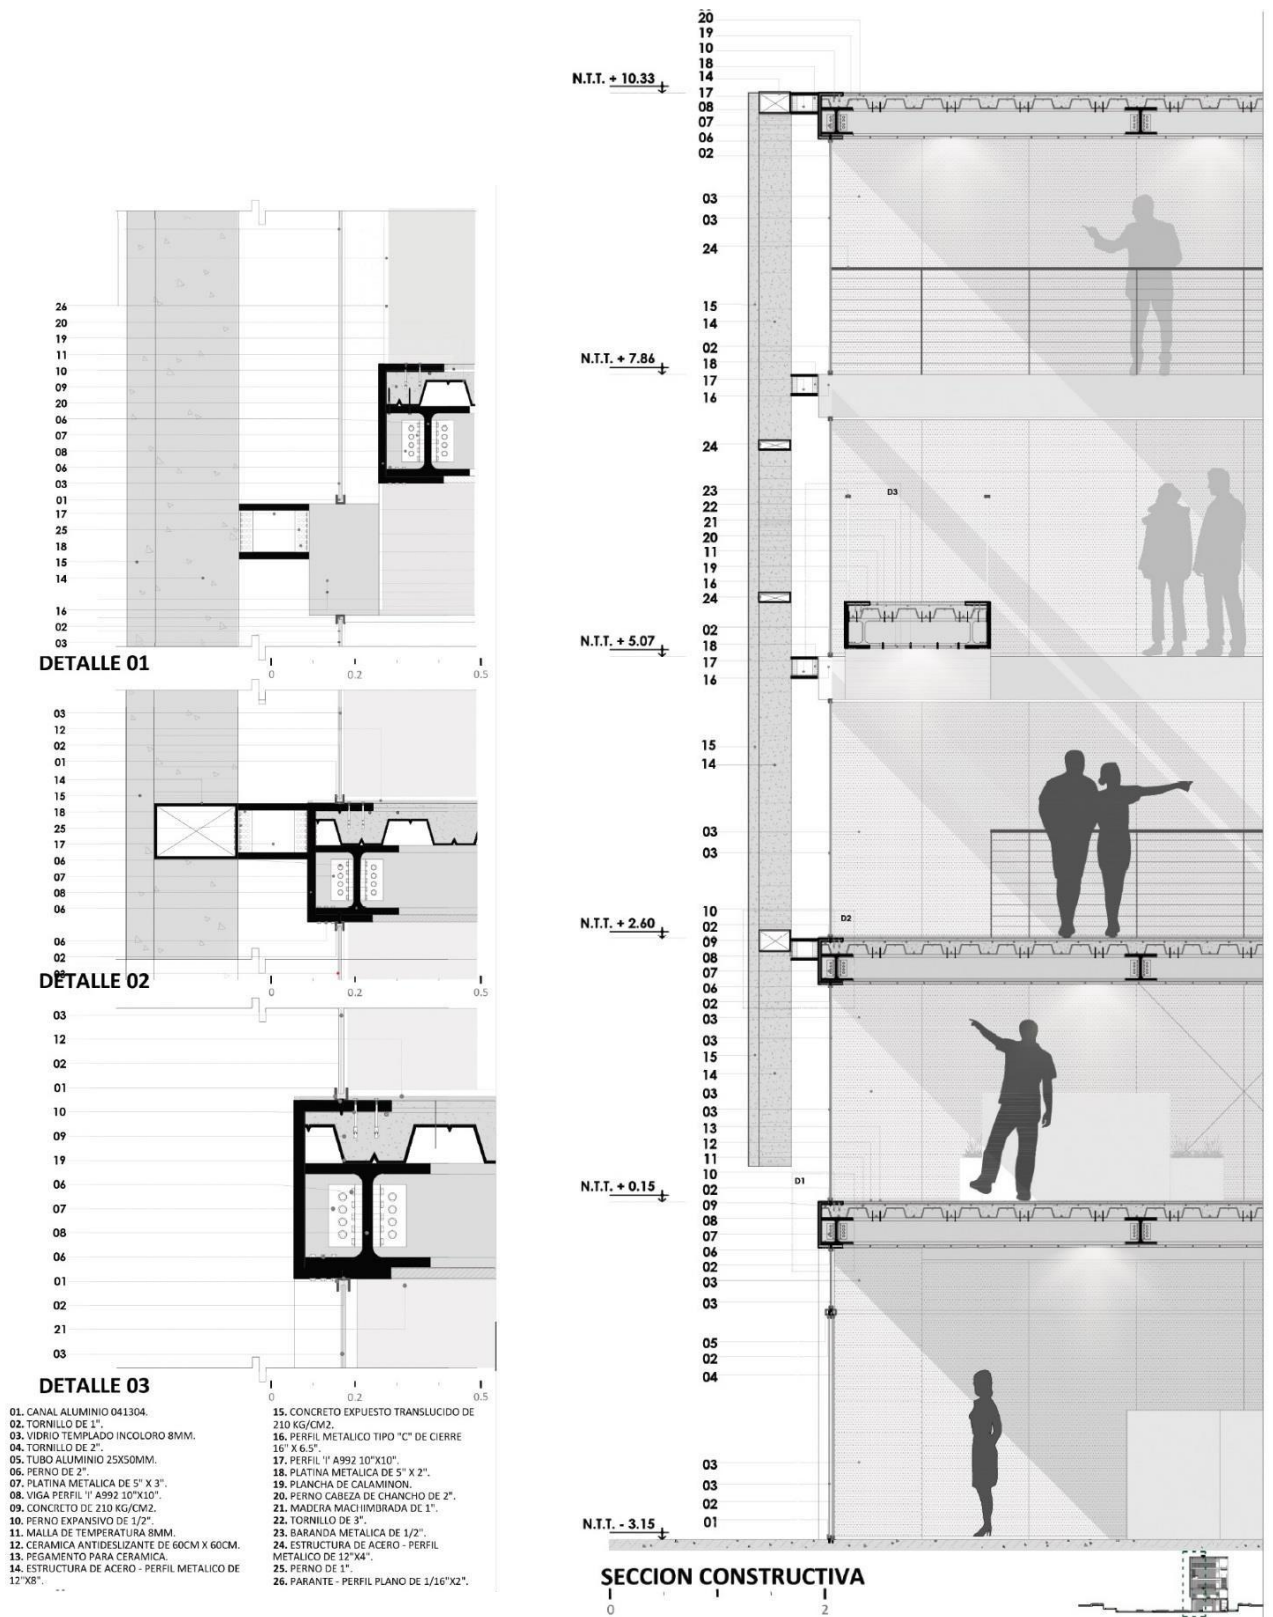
Esquema del Sector 03 + Detalles constructivos 02 y 03.
